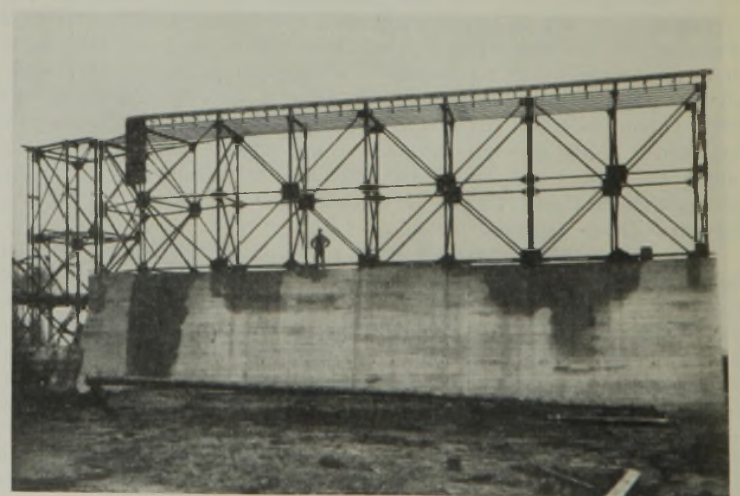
Kanalüberführung Olfen-Selm. Oberer Teil der Eisenfachwerk-Bewehrung mit Kantenschutz des südöstlichen Flügels.
